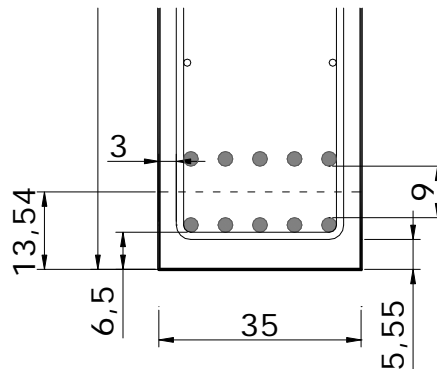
Detalle de la ubicación del refuerzo longitudinal por flexión
